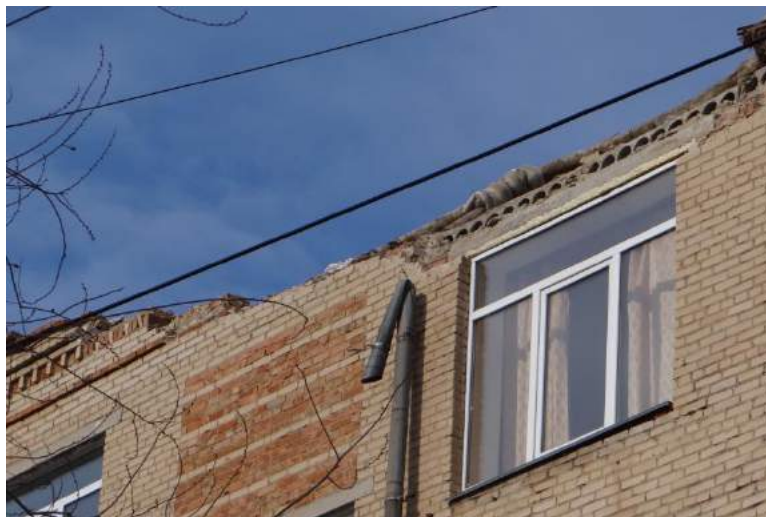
Разрушение кирпичной кладки карниза четырехэтажного здания
